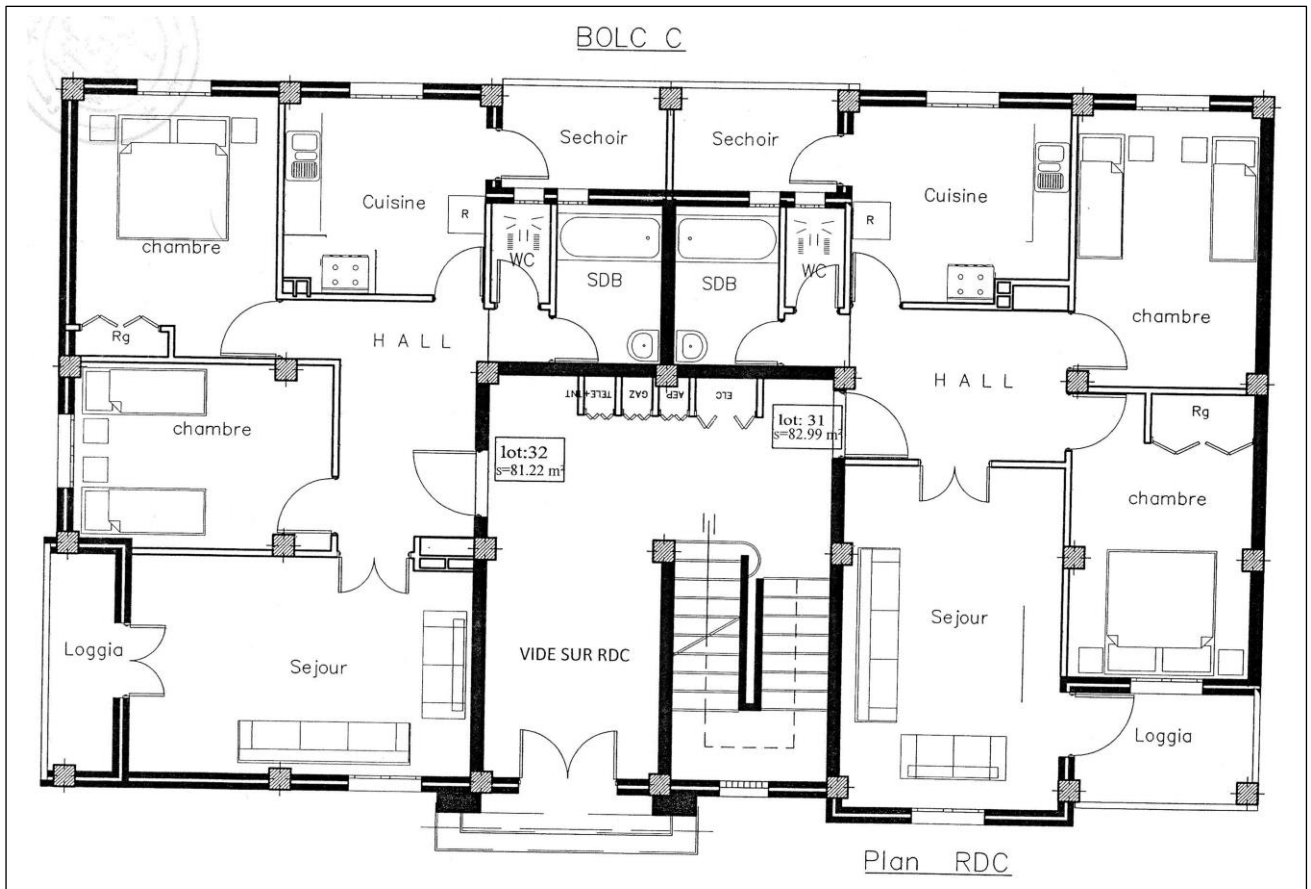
Exemple d'un plan illustratif d'un EDD qui correspond à un RDC
